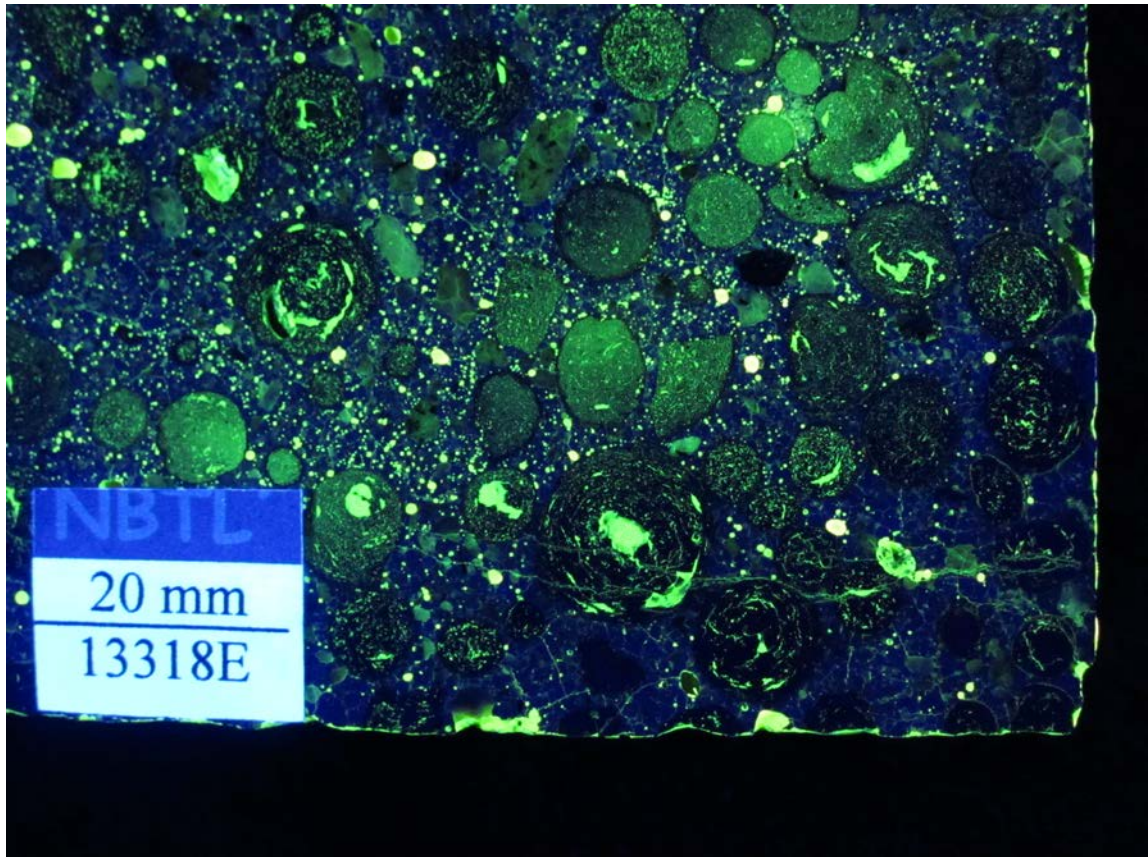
Planslip 13318E i UV-lys, detalj av sørsiden. Merk riss som går inn i betongen
